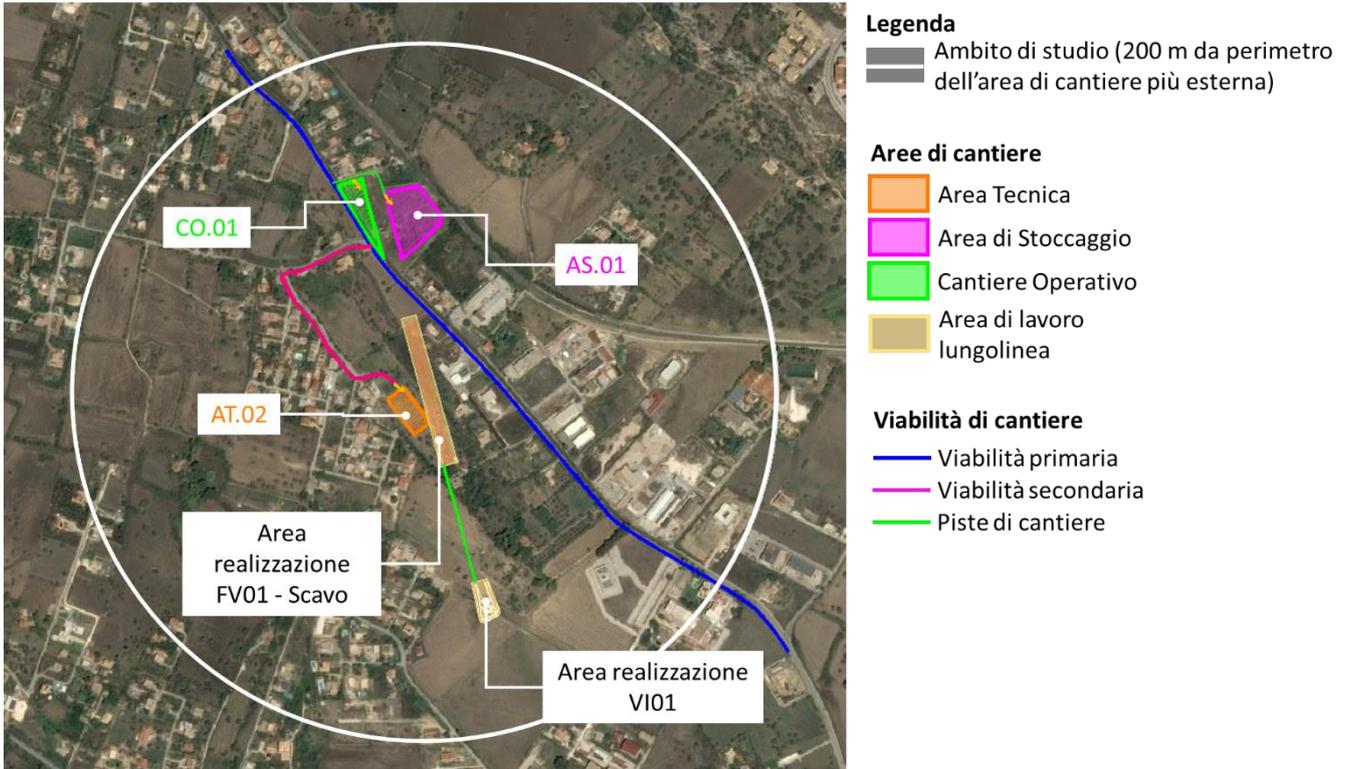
Scenario A: Localizzazione delle aree di cantiere fisso e di lavorazione, e viabilità di cantiere
